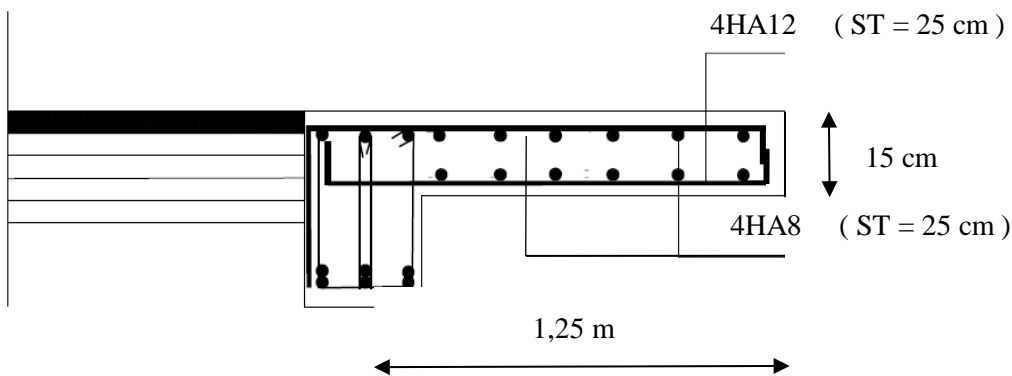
Schéma de Ferrailage du plancher en dalle pleine.
